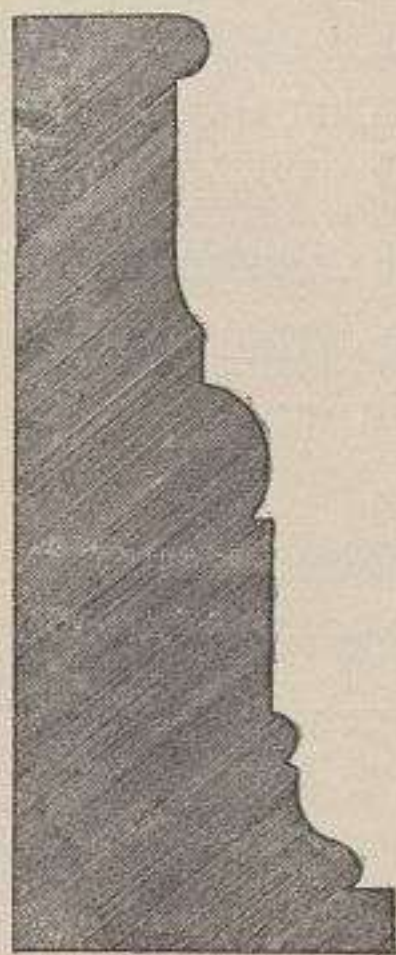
Basamento de pilastra en mármol. 1/8.
